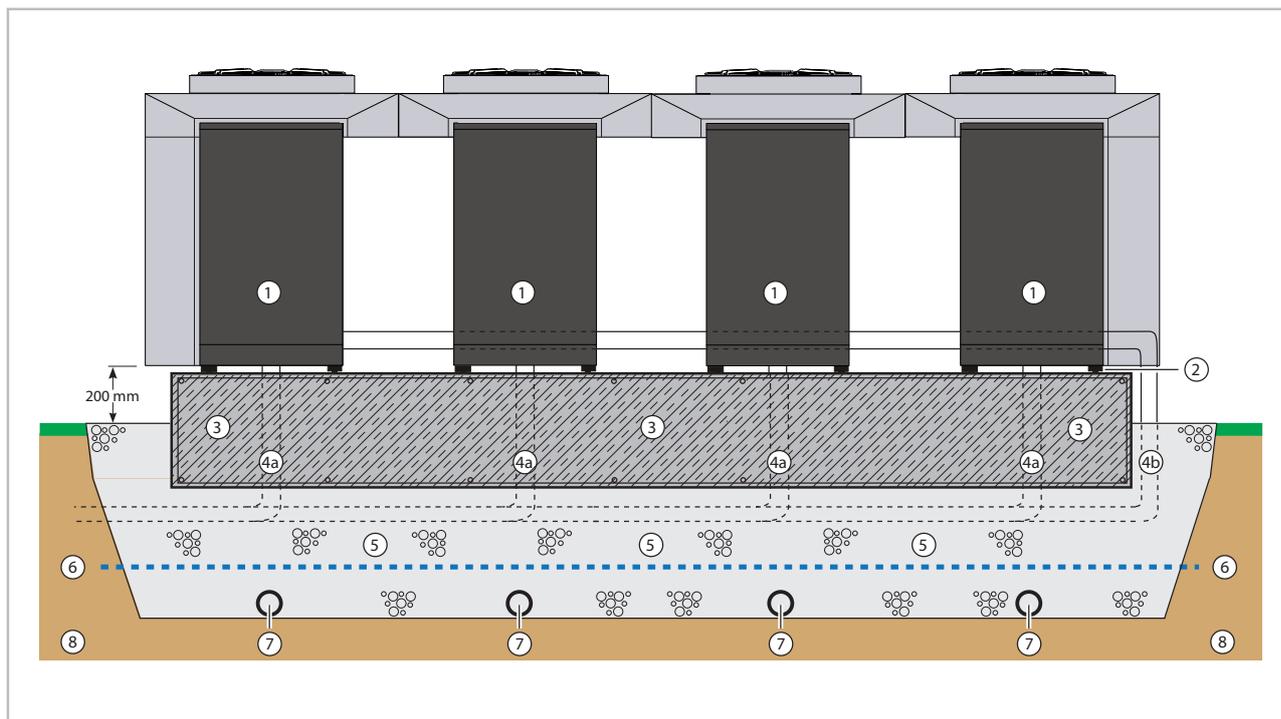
Conduite de condensat, évacuation de condensat et semelles filantes (coupe)
